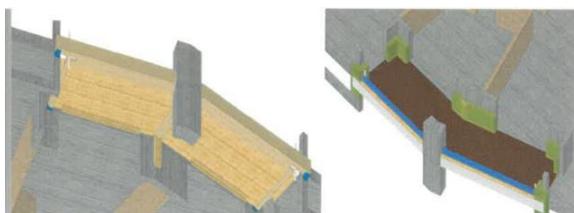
Detailansicht: Holzkonstruktion [Quelle: Holzbauingenieur EHK AG]
